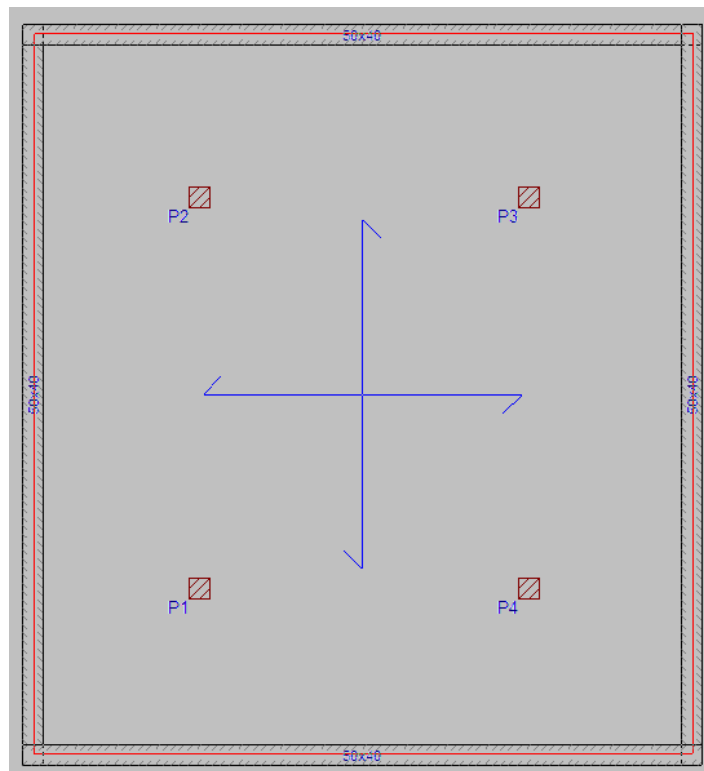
Losa de cimentación. Geometría. Fuente CypeCad
